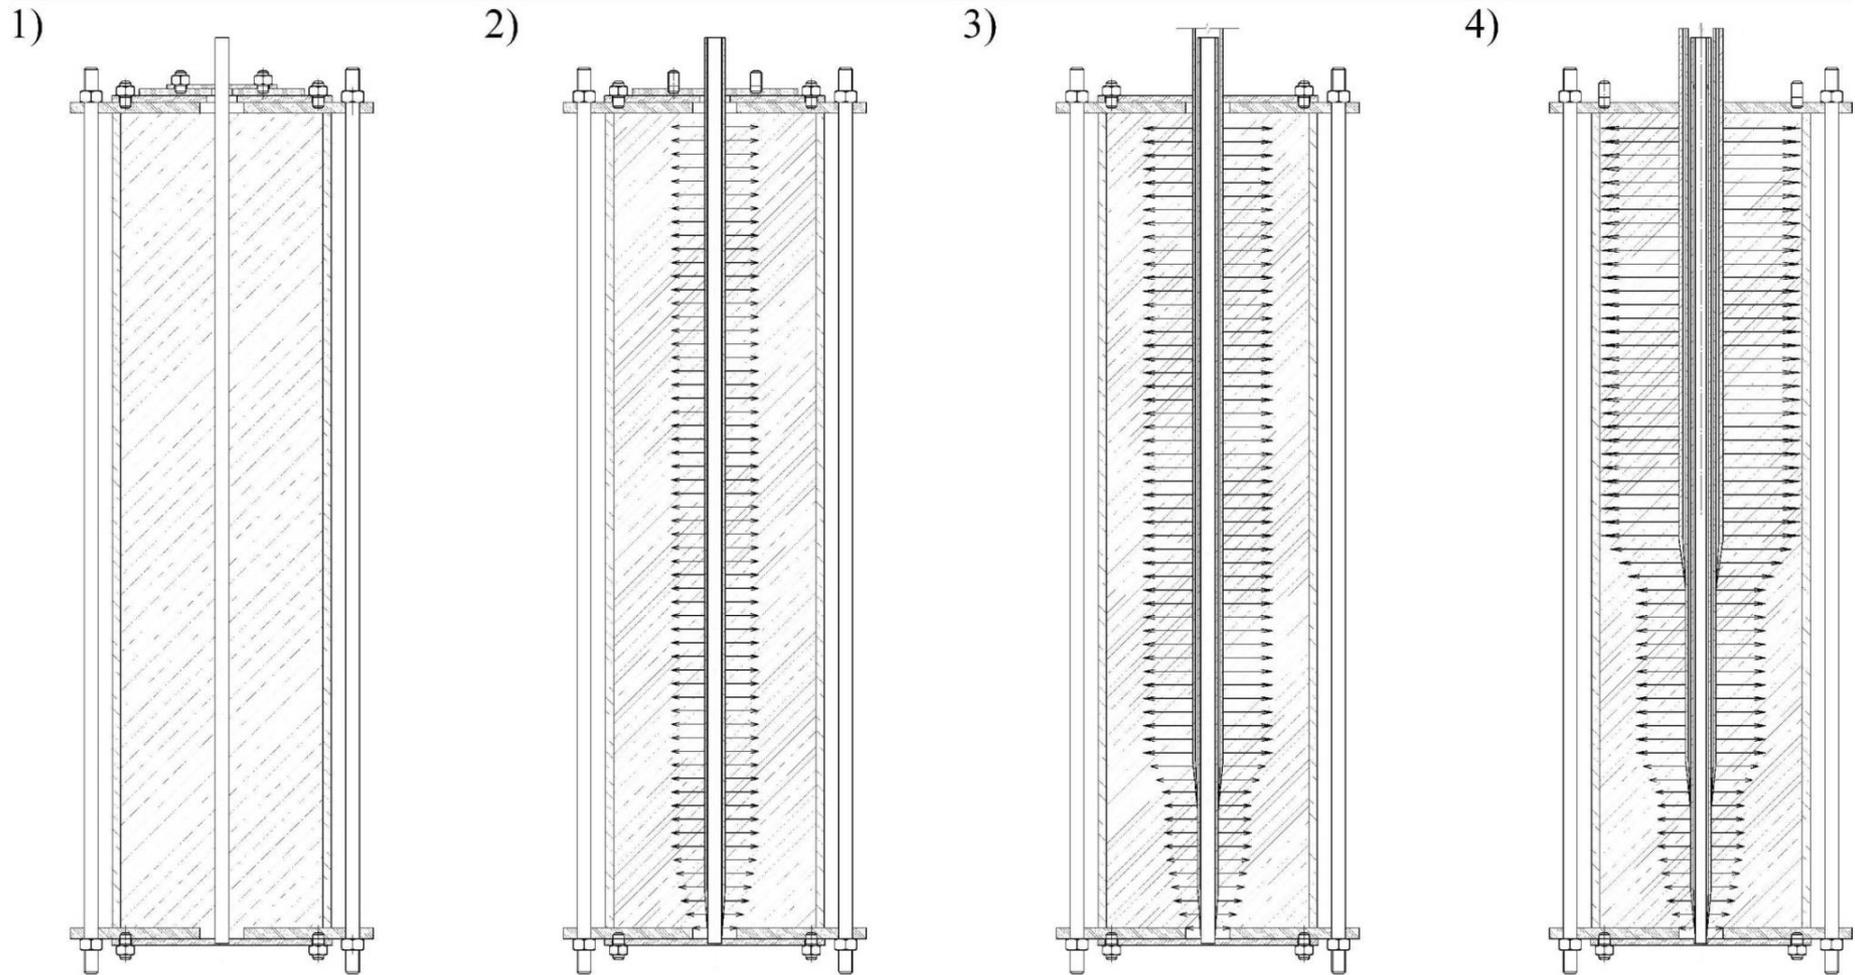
Схема изготовления предварительно обжатой трубобетонной колонны:
